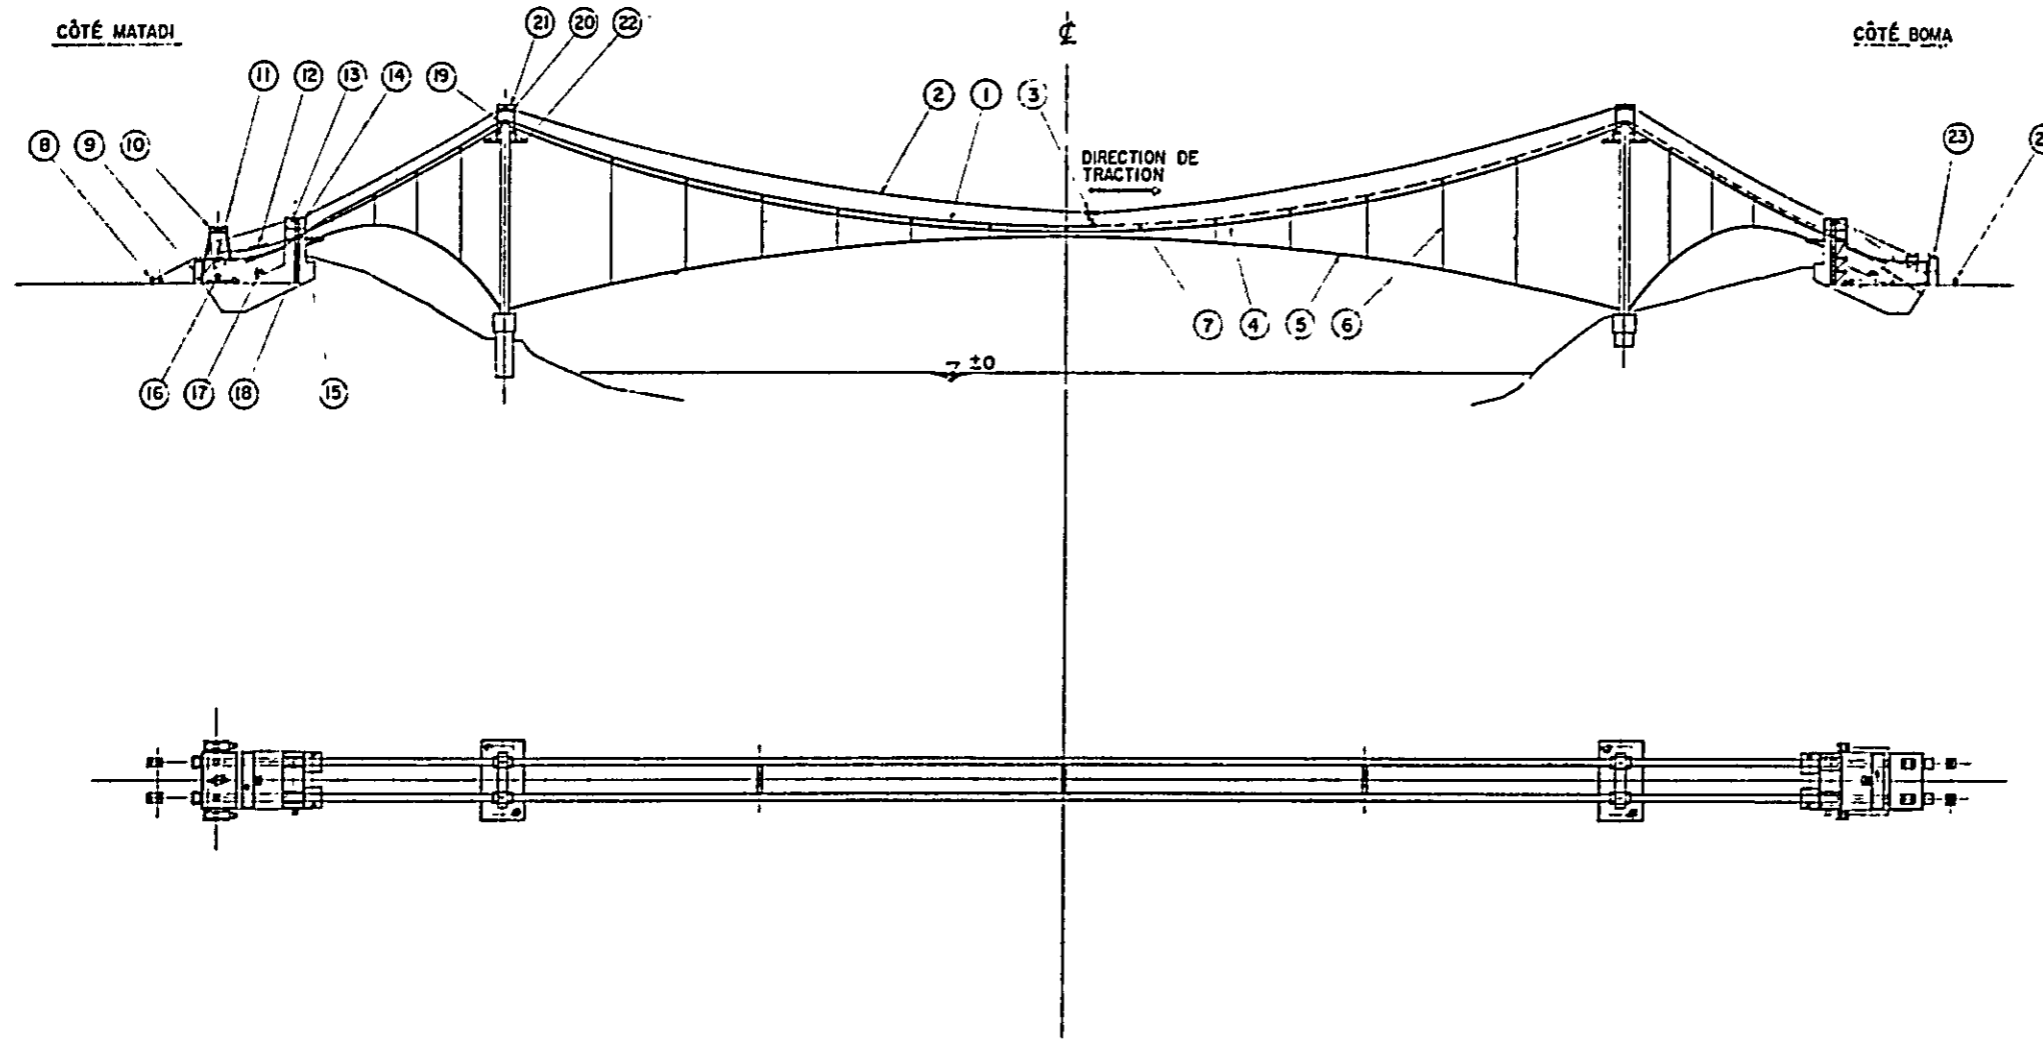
PLAN PRÉLIMINAIRE POUR LE SYSTEME D'INSTALLATION DES CÂBLES DU PONT
